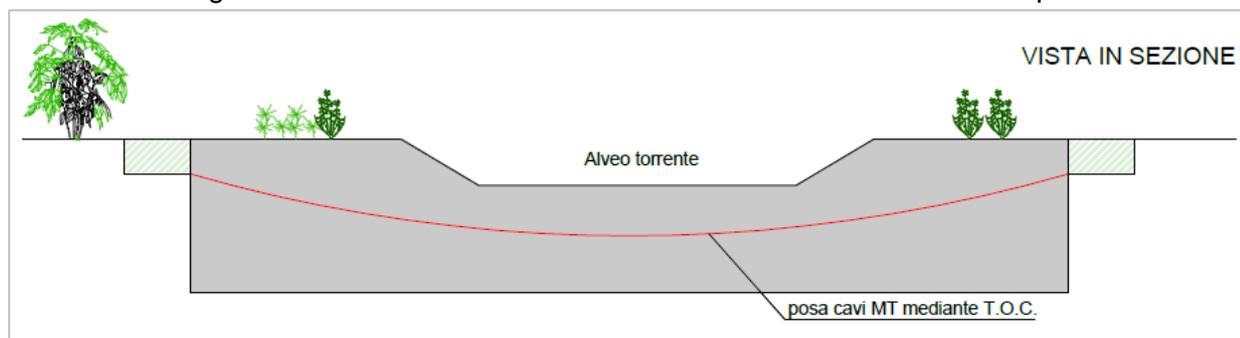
Sezione tipo attraversamento su torrente denominato “Torrente Serpente”
